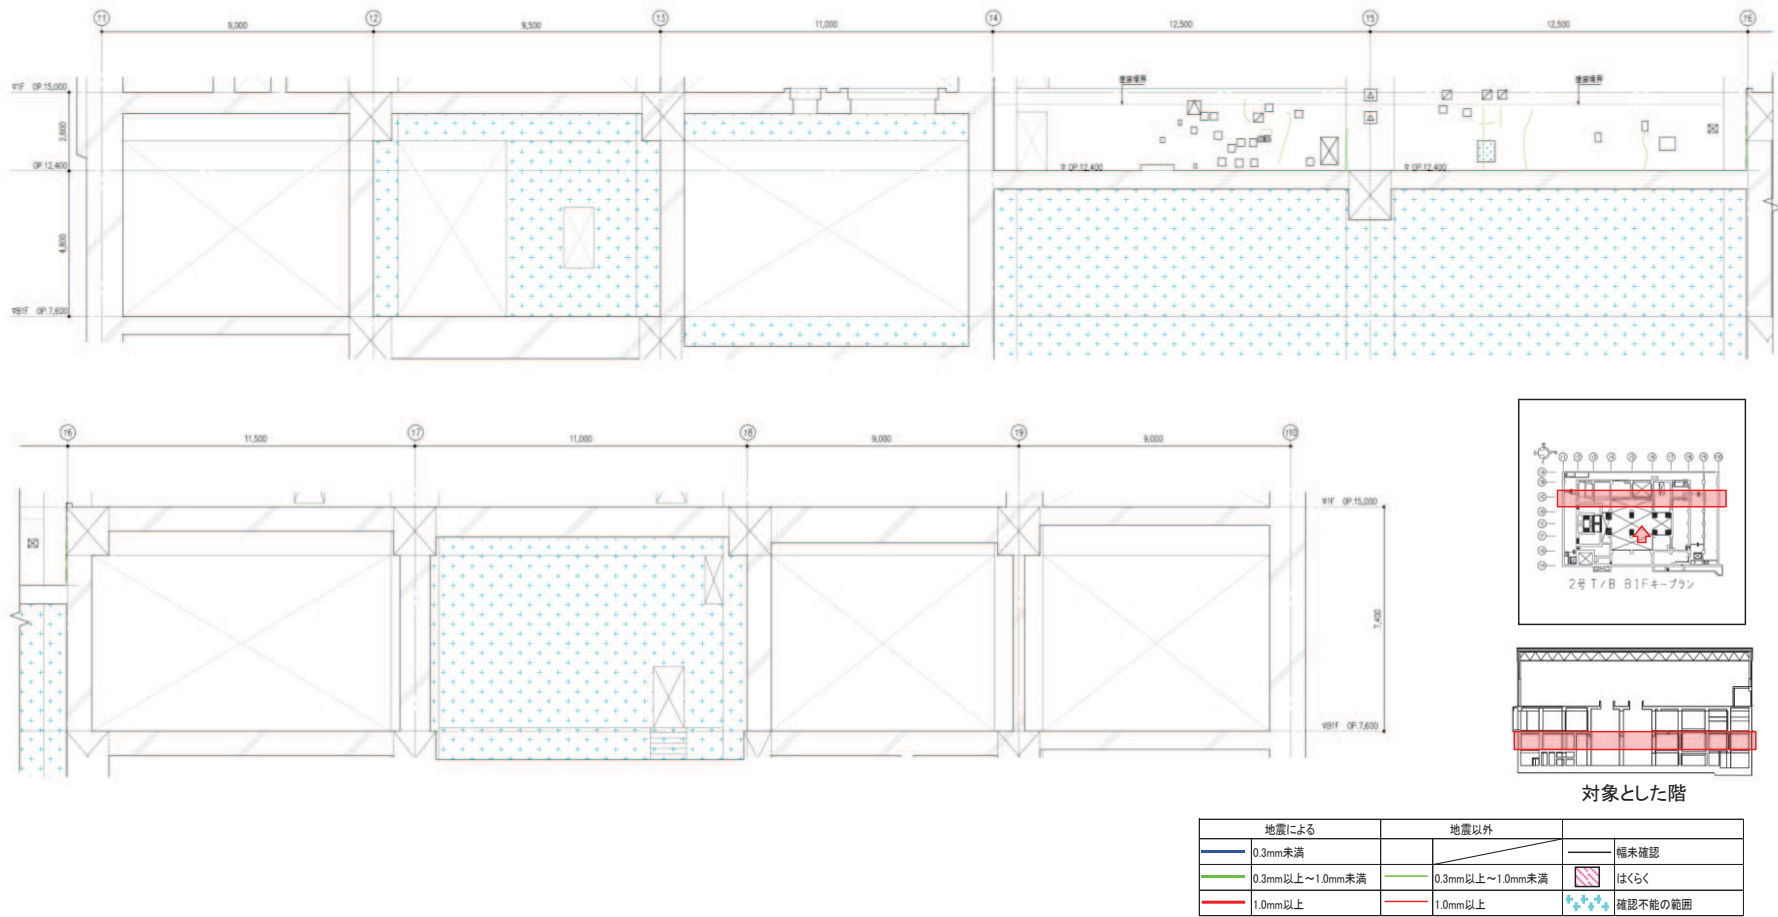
タービン建屋のひび割れ分布 耐震壁 (28) 地下 1 階 TC 通り
